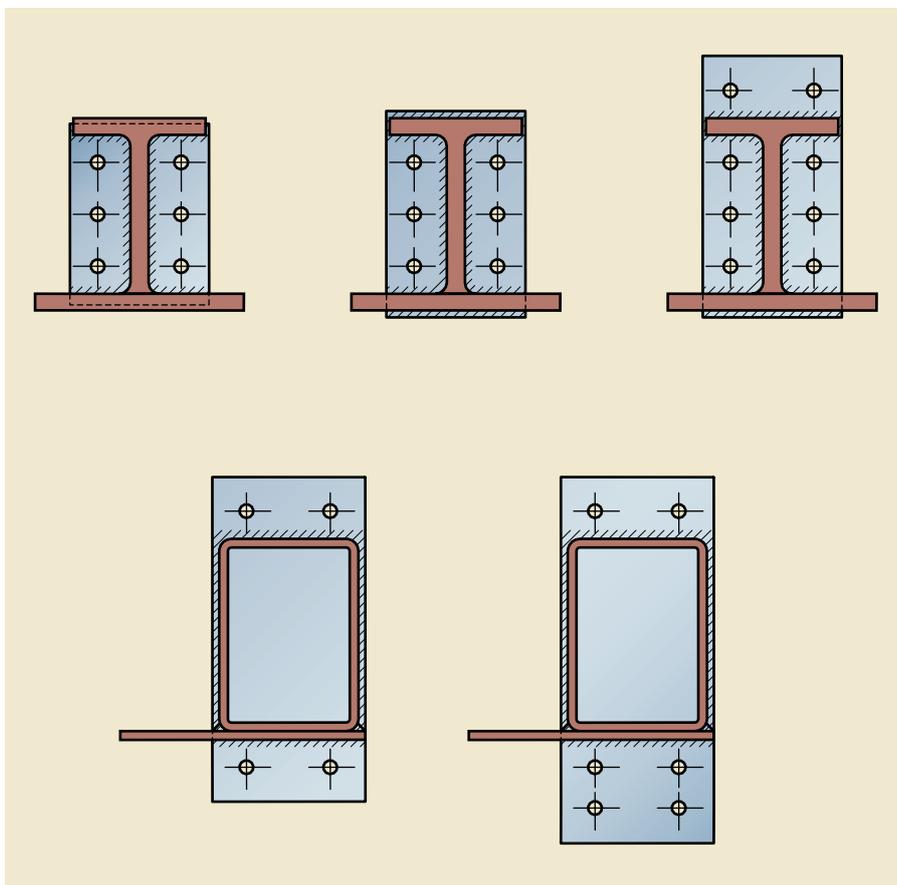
Platines d'about pleine hauteur pour les poutres de plancher intégrées et les poutres de rive
